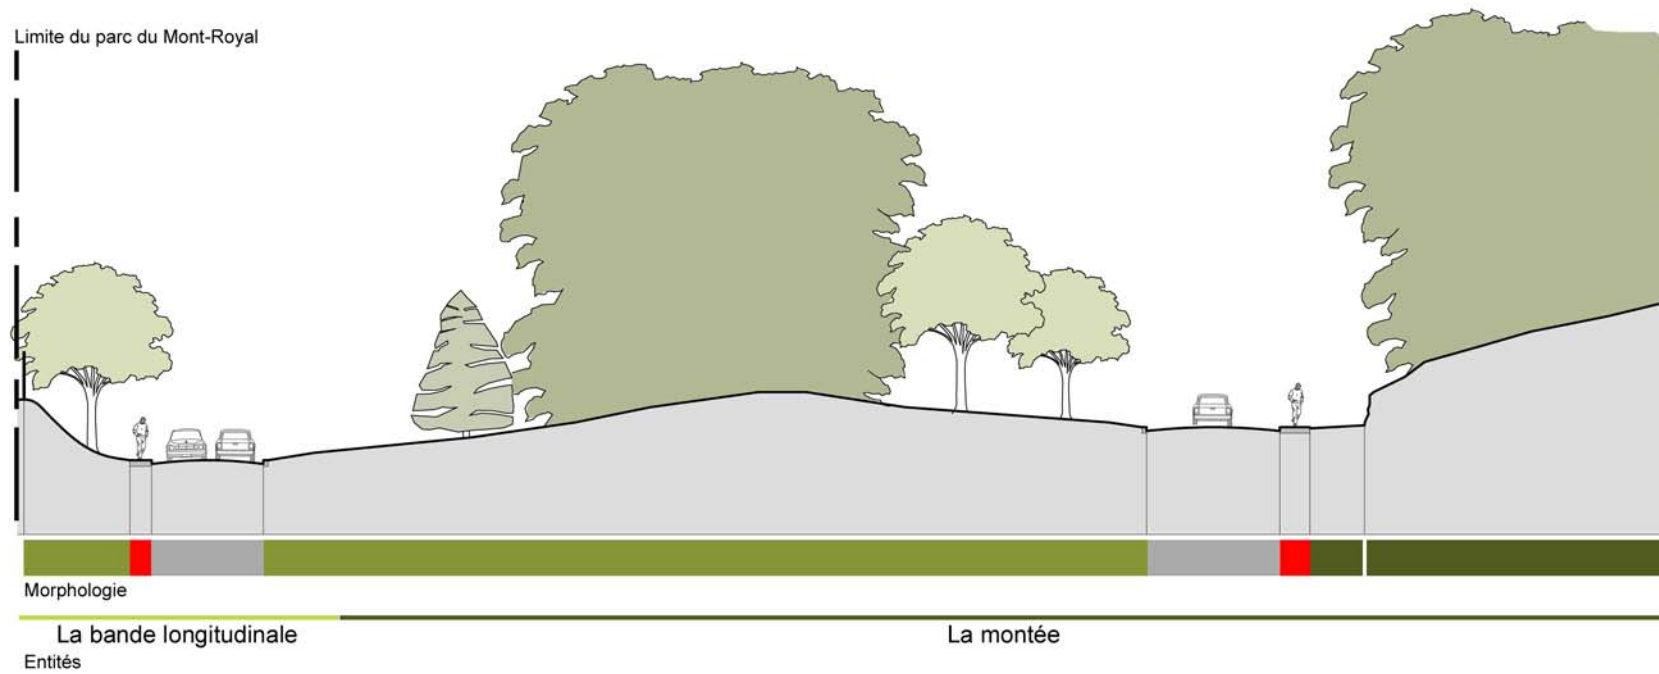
Coupe transversale 03, échelle 1:500, la bande longitudinale et la montée
